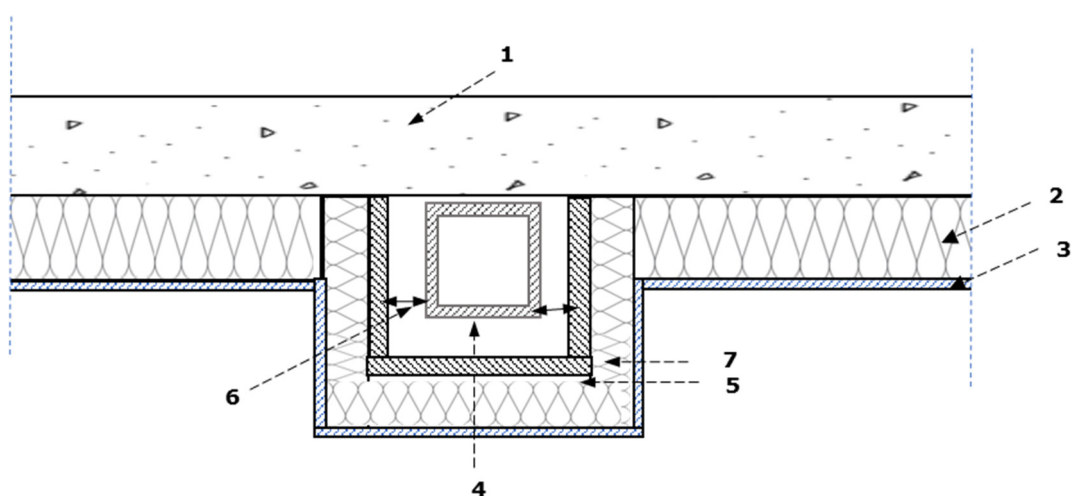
Coupe horizontale : conduit maçonné adossé à un mur
